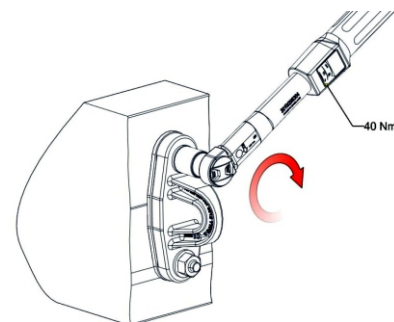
Serraggio del tassello mediante una chiave dinamometrica
